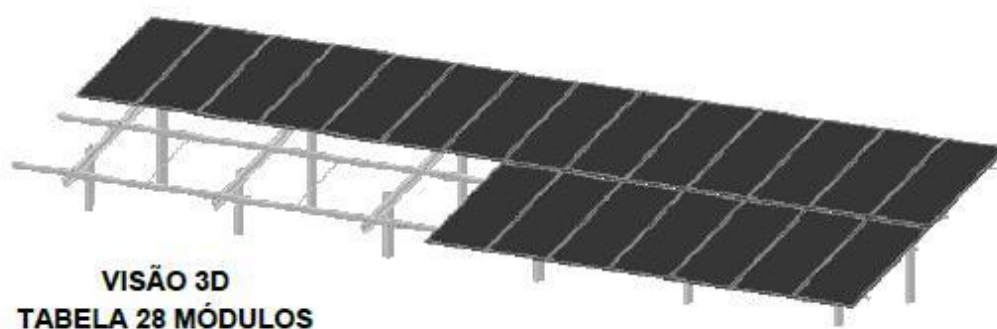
Detalhe da estrutura proposta (2v14)
